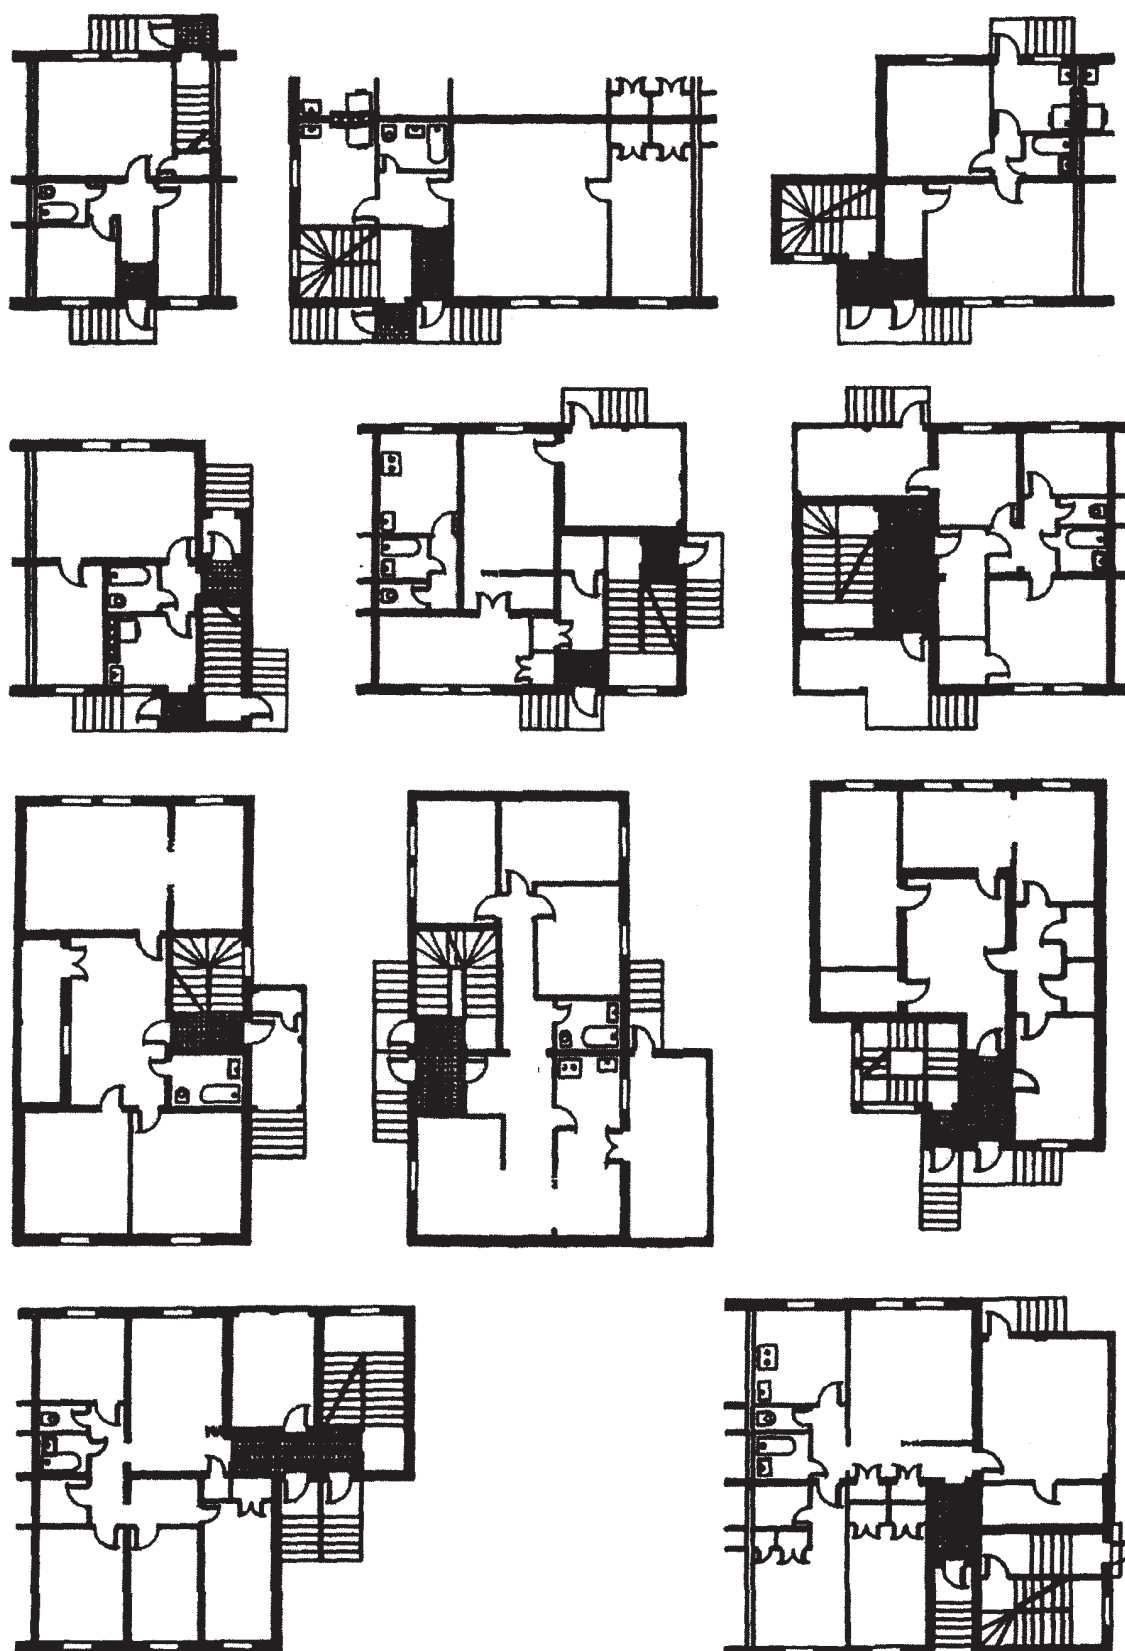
Планировочные схемы входных узлов в квартиры, расположенные на 1-м и 2-м этажах малоэтажных жилых зданий
